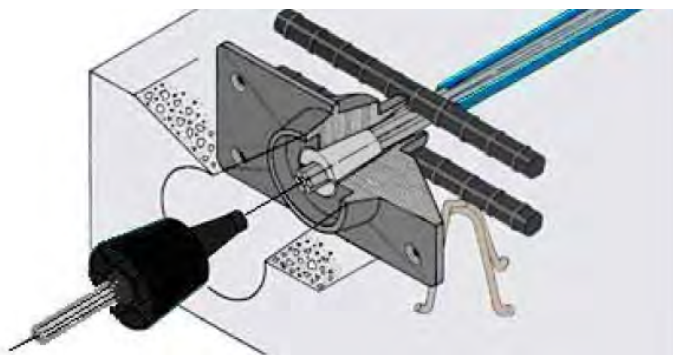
Принципиальная схема системы предварительного напряжения с одиночной прядью без сцепления с бетоном (unbounded monostrand PT system)
